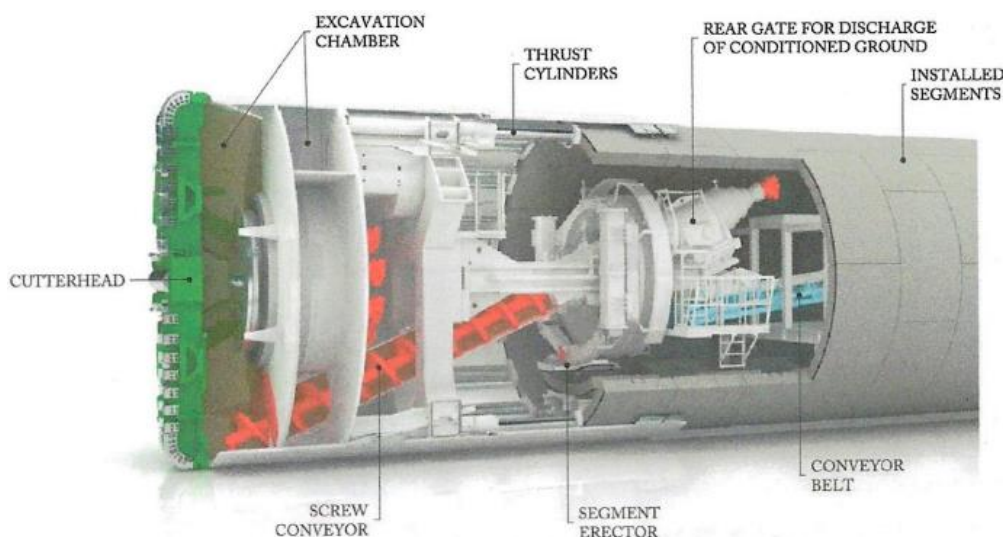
Sección longitudinal de un escudo EPB fabricado por Herrenknecht AG.
